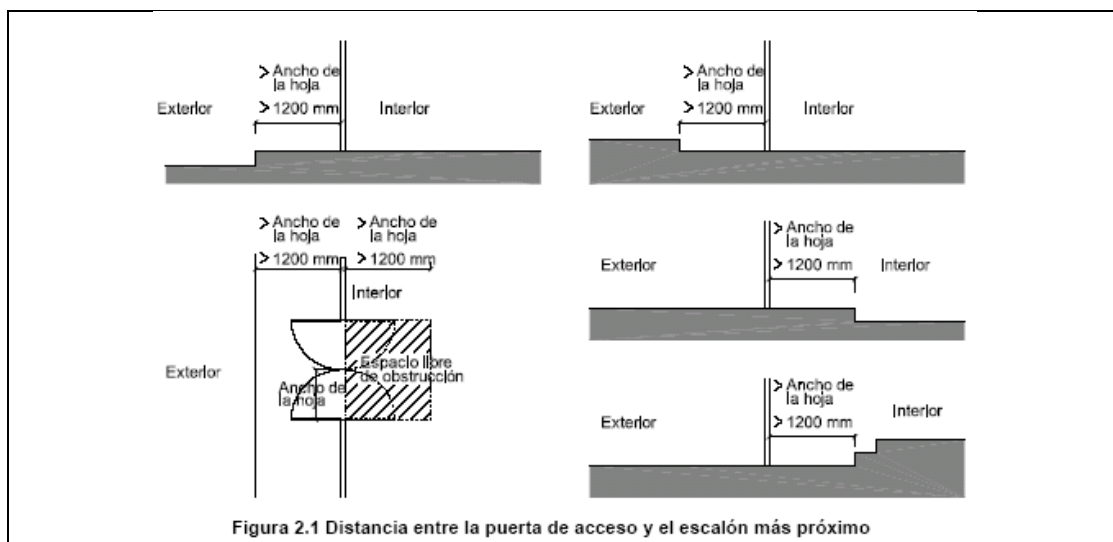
Distancia entre la puerta de acceso y el escalón más próximo
